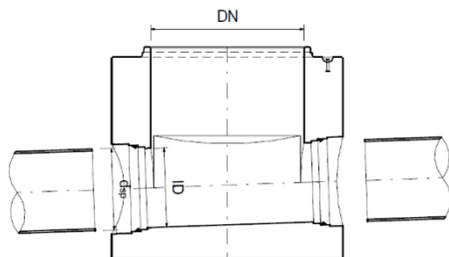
Anschluss mit duktilen Gussrohren mit Gefälle J ≤ 150 ‰
